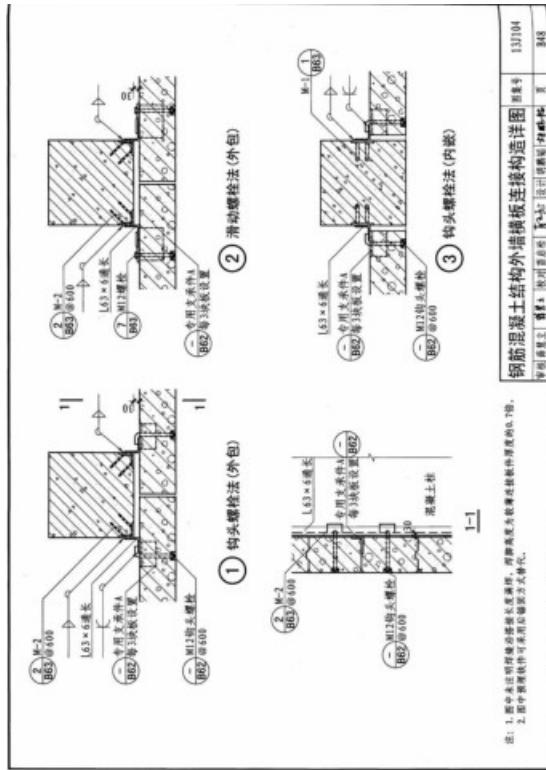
钢筋混凝土柱梁结构中连接板根部连接构造详图
